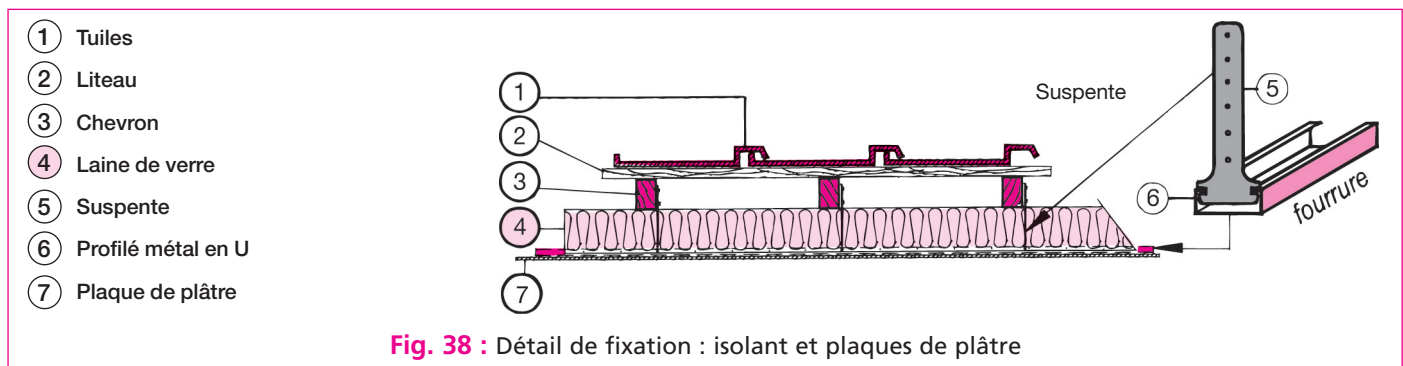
Détail de fixation : isolant et plaques de plâtre
